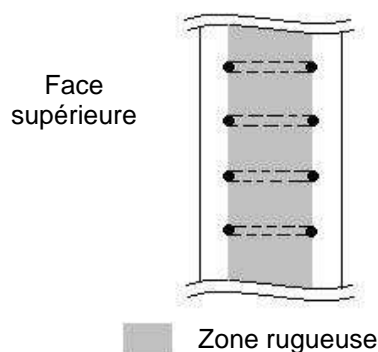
Rugosité des poutres de planchers avec cadres dépassants
